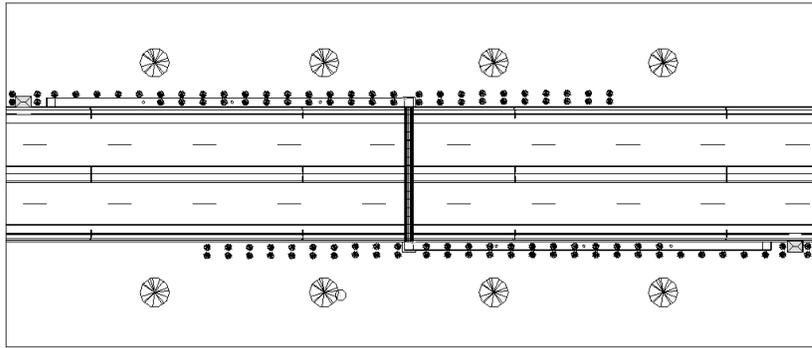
Vista en planta de la planimetría general de la Pasarela Peatonal
